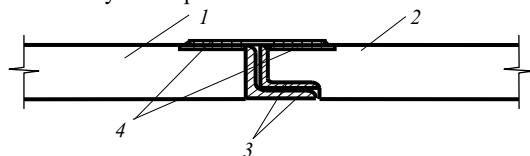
Схема вузла з'єднання плит у збірному сталезалізобетонному безбалковому перекритті
